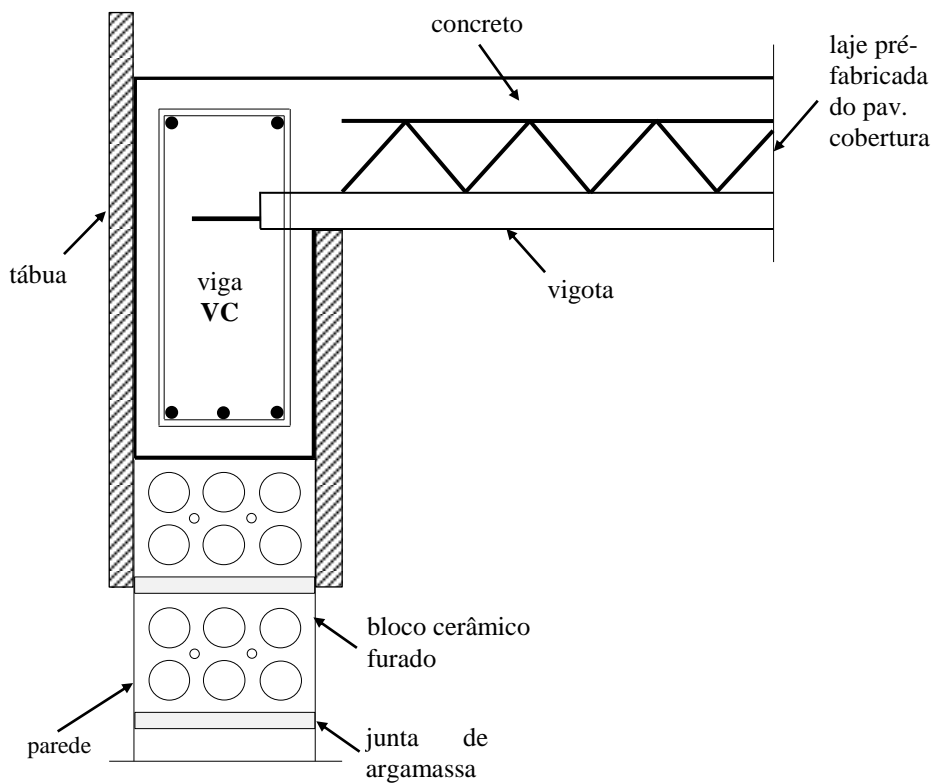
Ligação de laje da cobertura sobre viga de concreto.
